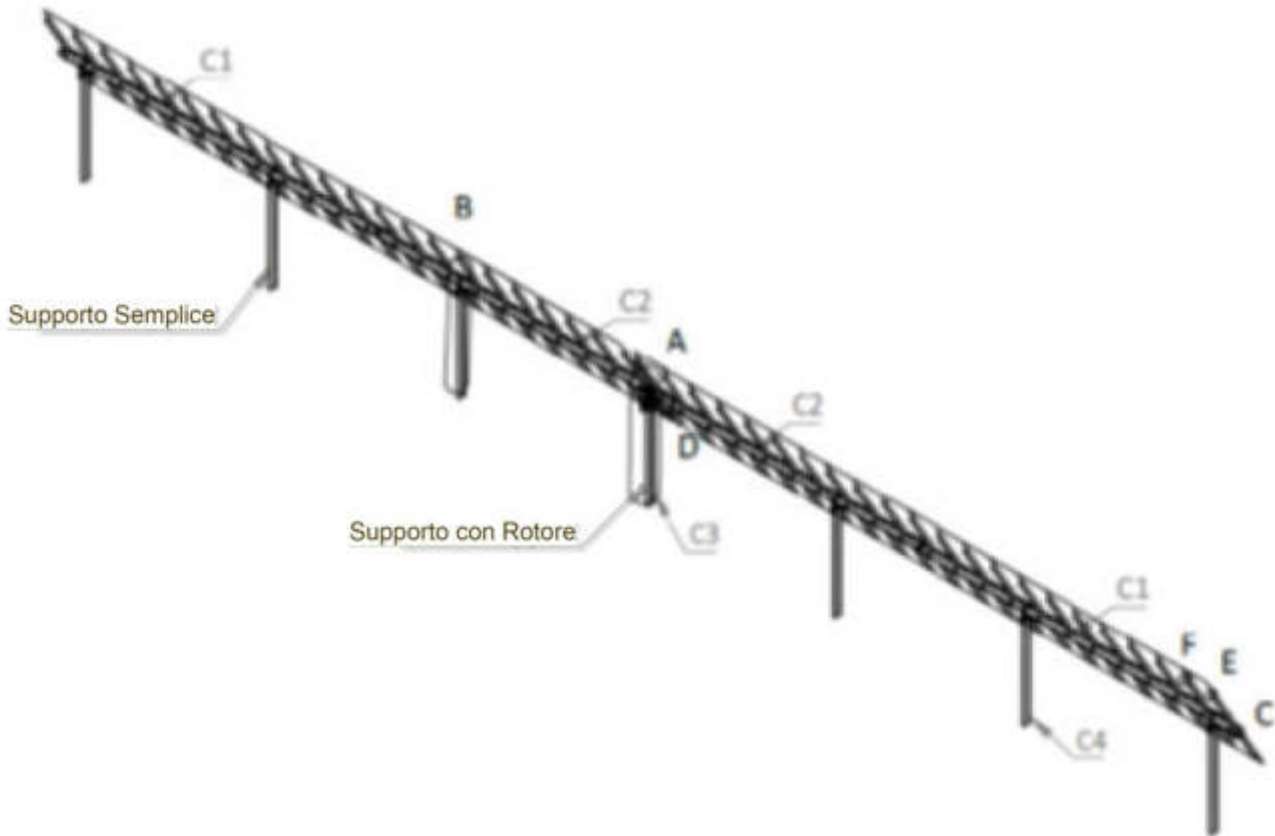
Pianta e prospetto tracker - SF7 2x28 (56 moduli 2 strings)
